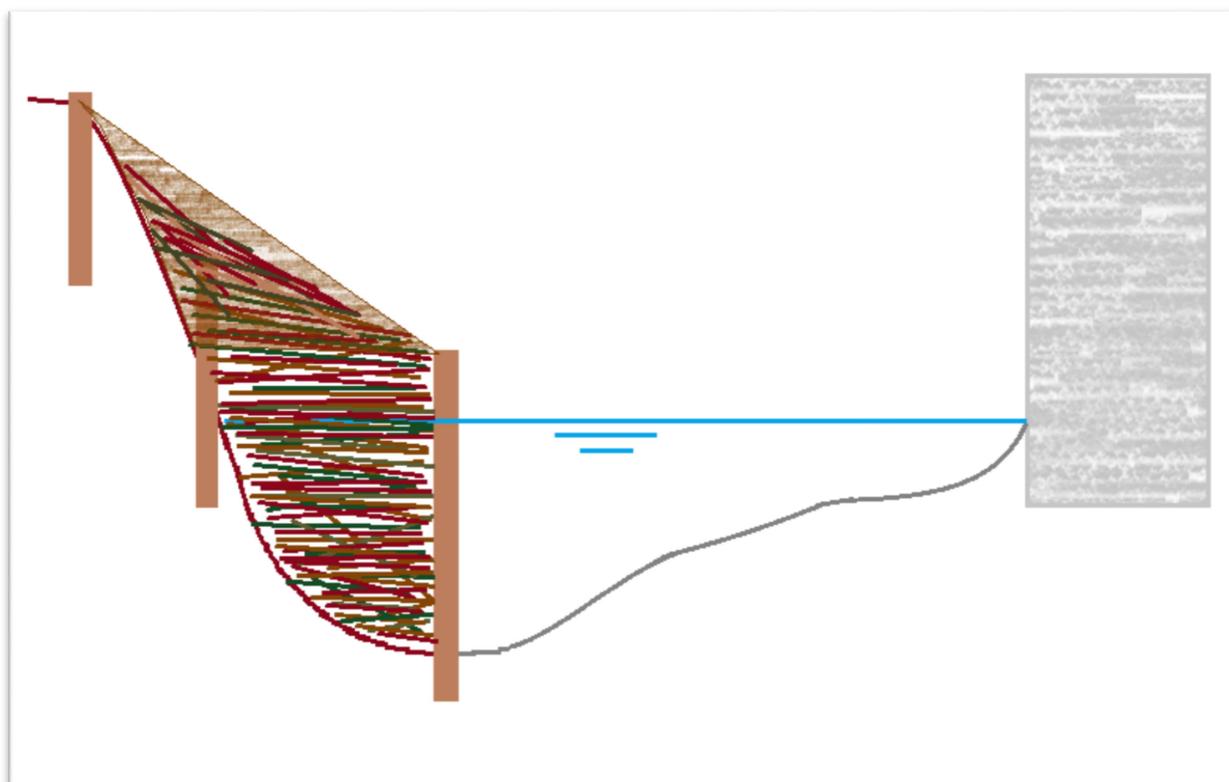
Plan d'implantation du peigne végétal d'une longueur de 12ml et d'une surface de 24 m<sup>2</sup>
